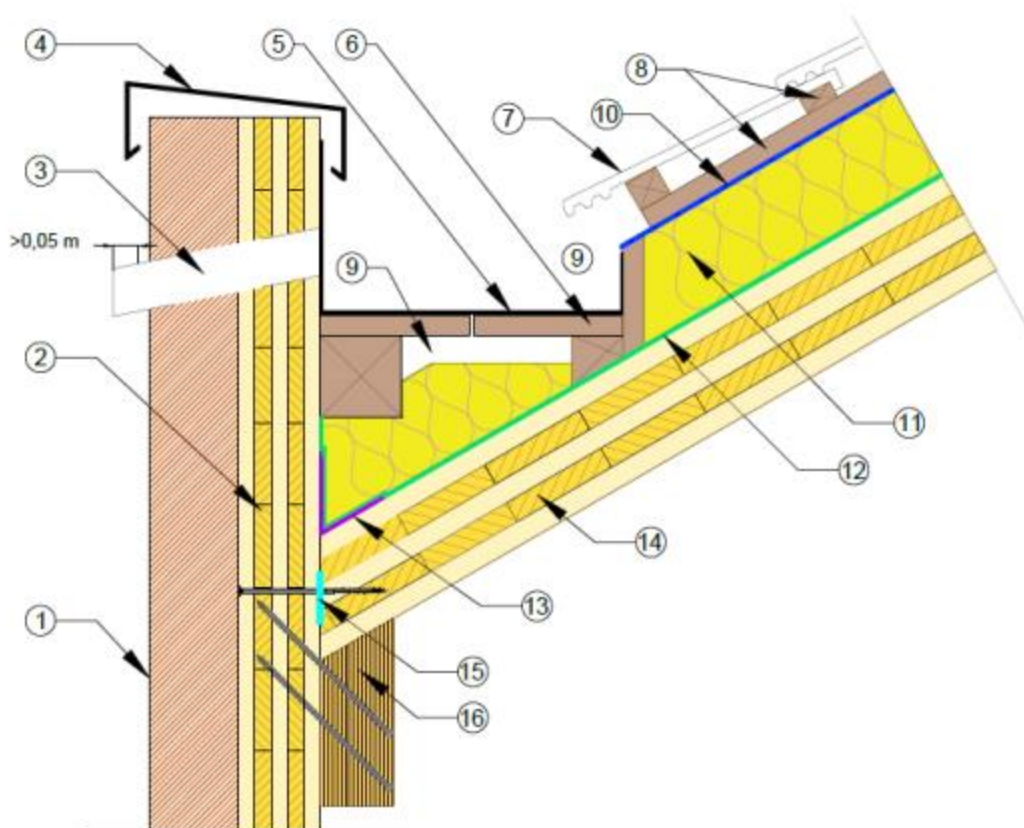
Traitement de l'égout avec panneau structural en débord - Couverture en plaques nervurées métalliques ou ondulées fibres-ciment avec chevron de ventilation - Cas où la section des ondes des plaques ondulées n'est pas suffisante pour la ventilation en sous-face - Climat de plaine
